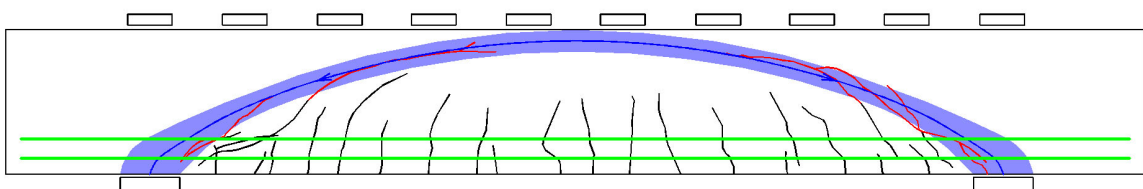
Balken BO 2 mit überlagerter Druckparabel und zugehörigen Rissen
